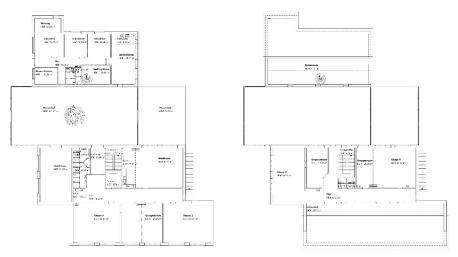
Grundrisse EG & OG, Lemwerder-Mitte
